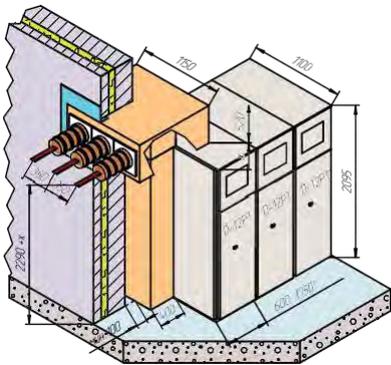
Шинный ввод сбоку с боковой приставкой
